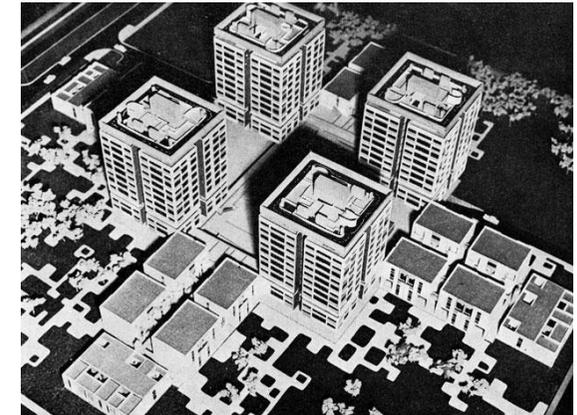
Vista de la maqueta del proyecto de la Residencial San Felipe
